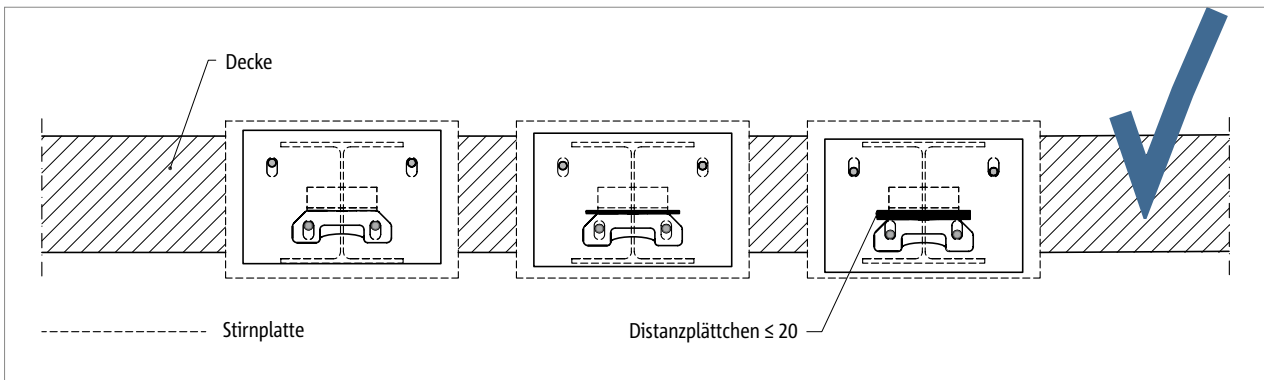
Schöck Isokorb® RT Typ SK: Korrekter Einbau mit Verwendung der Bohrschablone ermöglicht das Erreichen der erforderlichen Einbaugenauigkeit
